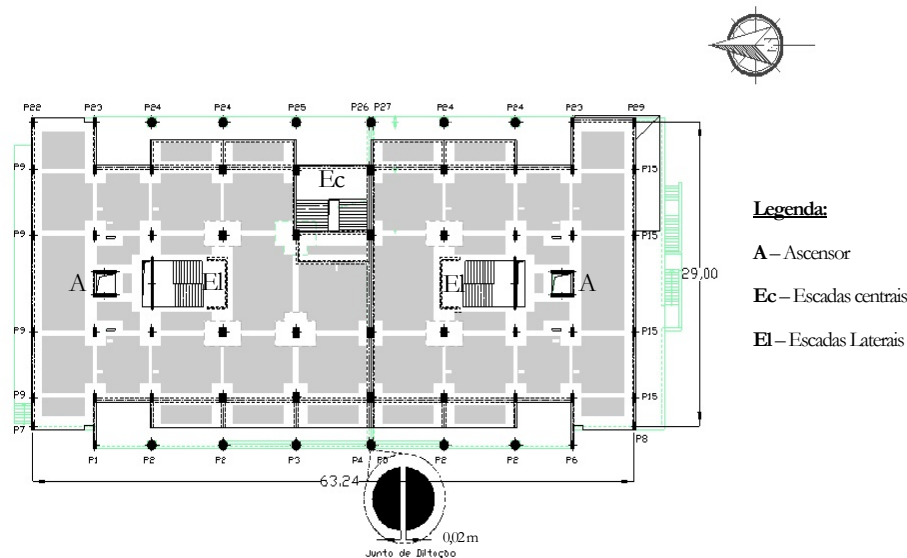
Planta do piso 1 sobreposta à planta do piso 0 com pormenor da junta e orientação.
